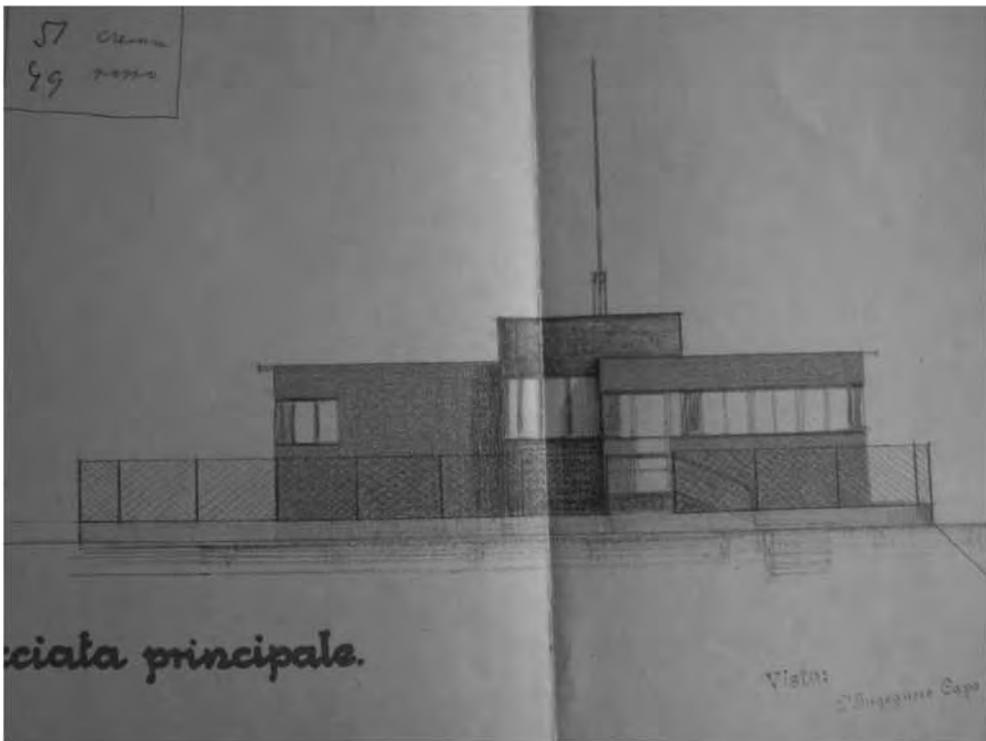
Dispensario antitubercolare, Clana, prospetto (Archivio di Stato, Fiume)
